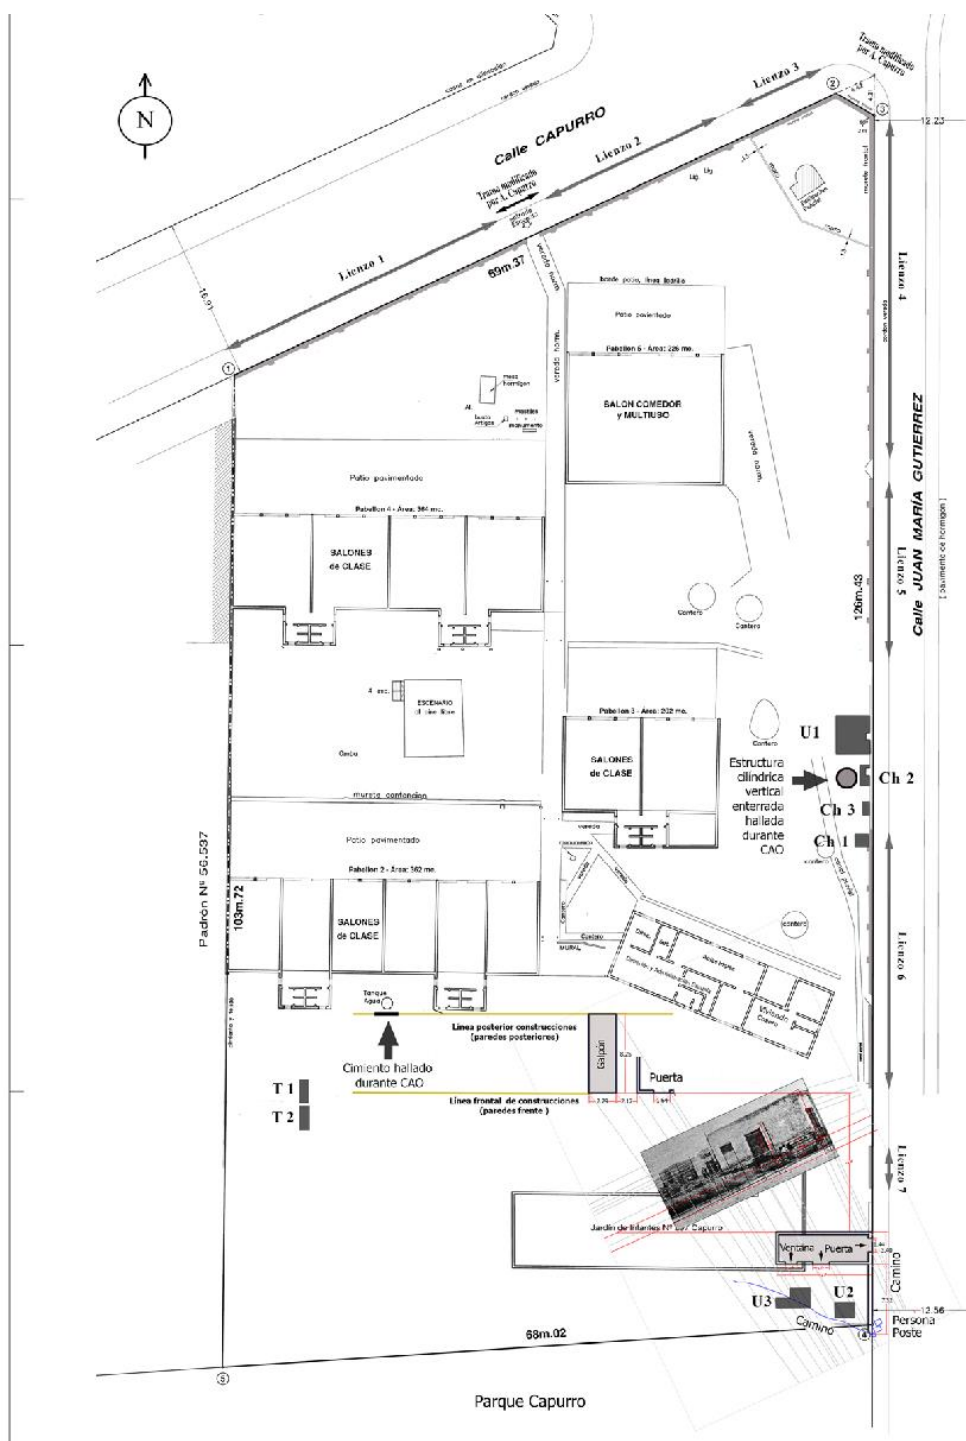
Plano actual de la escuela y jardín de Infantes donde se indican: 1.- los lienzos del muro perimetral que corresponden al caserío; 2.- los sectores de dicho muro modificados por A. Capurro aproximadamente en 1880; 3.- los sondeos y excavaciones arqueológicas (U1, U2, U3, Ch1, Ch2, Ch3, T1 y T2); 4.- la cisterna y del cemento hallados durante el Control Arqueológico de Obra. La superposición de la planta de las construcciones del "caserío" reconstruidas a partir de la foto, permite observar que el último cimiento referido coincide en ubicación y dirección con la línea posterior de las construcciones. (Fuente: L. Mazz y R.Bracco, 2014).
